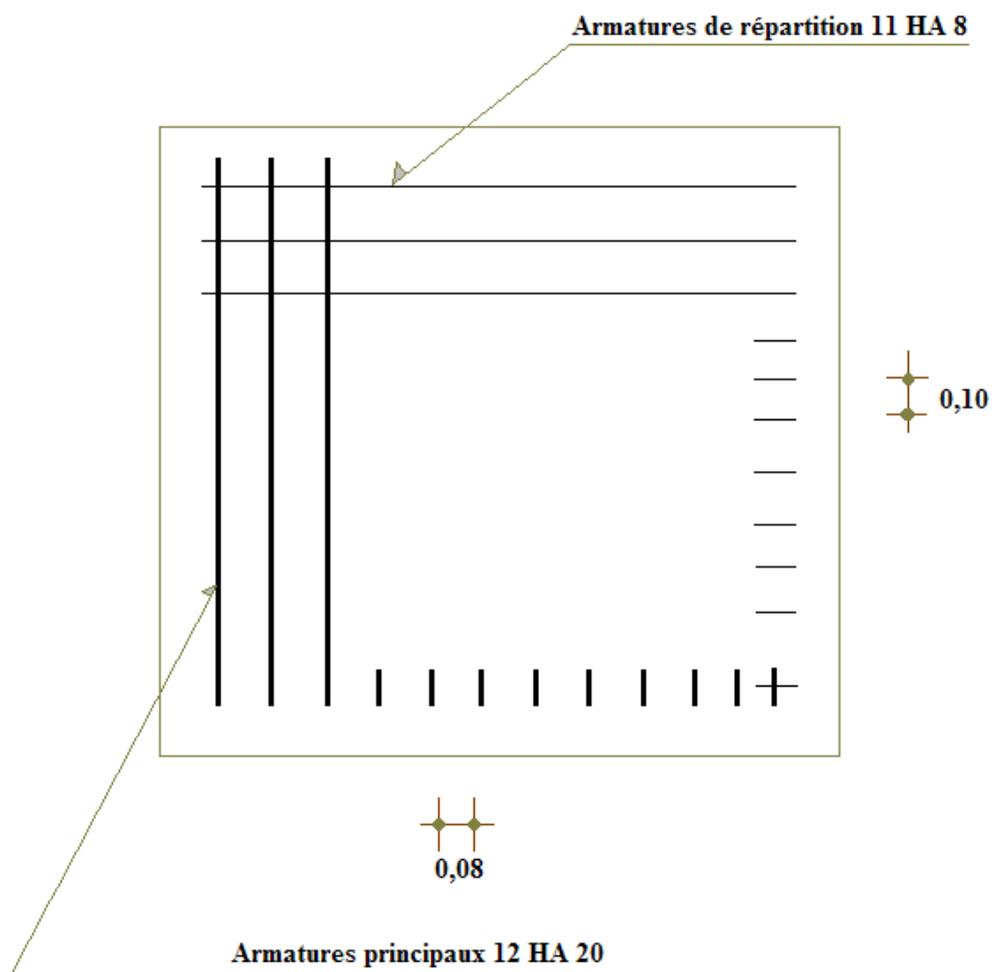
Principe de ferrailage des armatures dans 1 m² de paroi du canal principal
